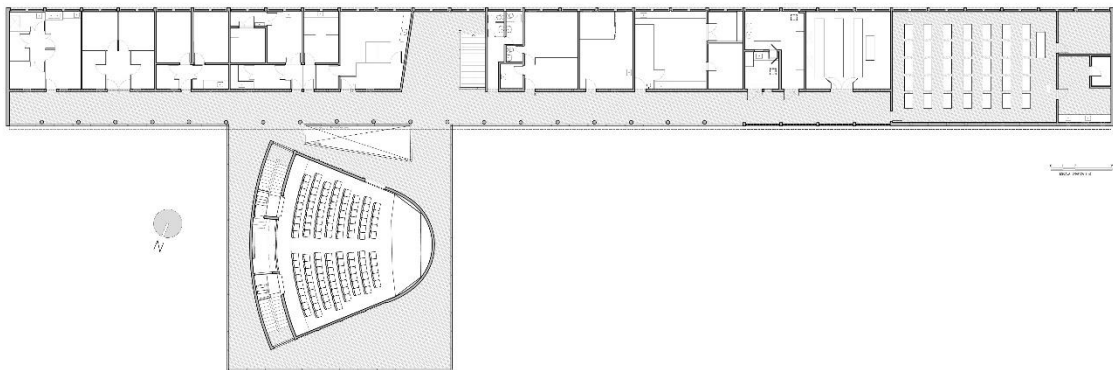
Pavilhão Arthur Neiva: planta do 2o pavimento, 2016. Fonte : DPH/COC/Fiocruz
